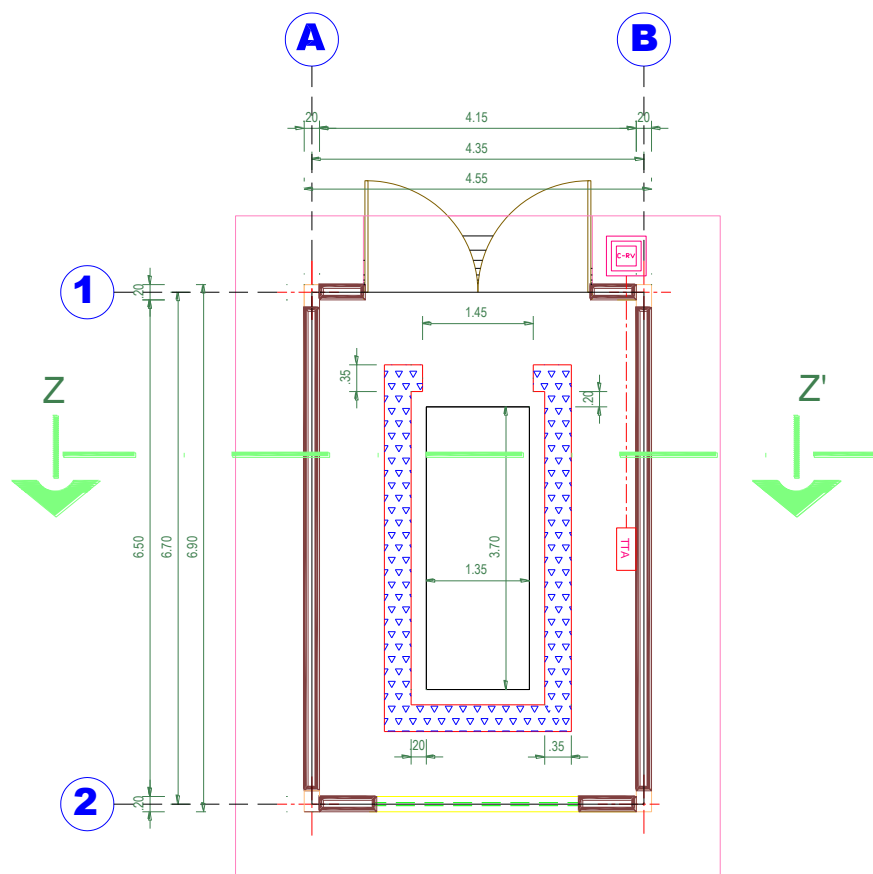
Planta arquitectónica local del generador de 250KVA
